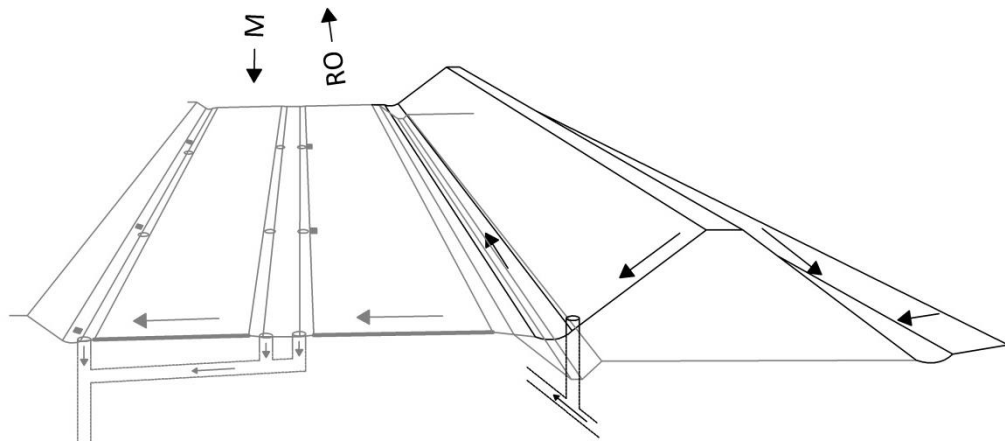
Entwässerungsschema – Weyarn-Ost, Bau-km 0+941 bis Bau-km 1+165
